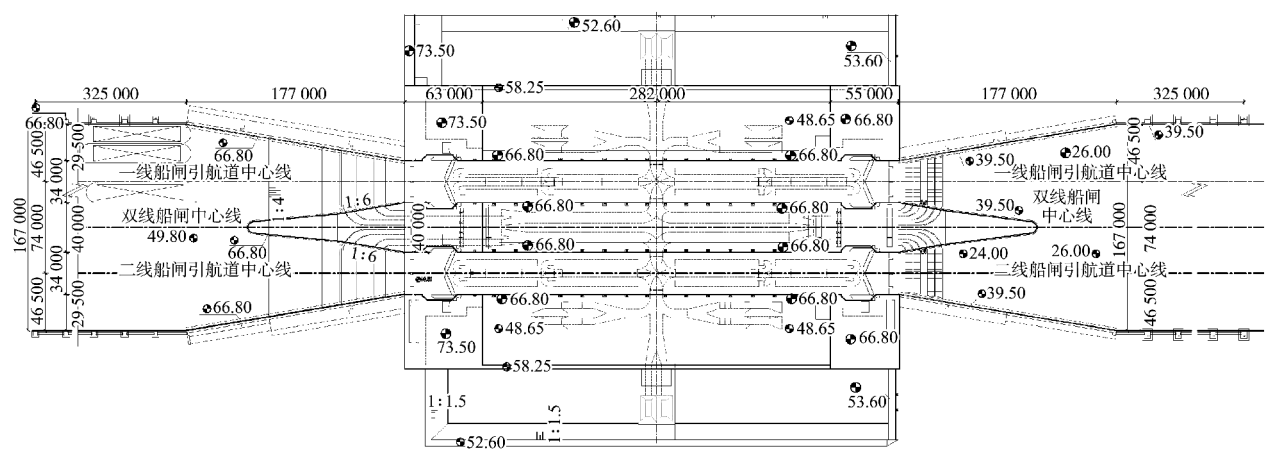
双线船闸平面布置 (尺寸: mm; 高程: m)
